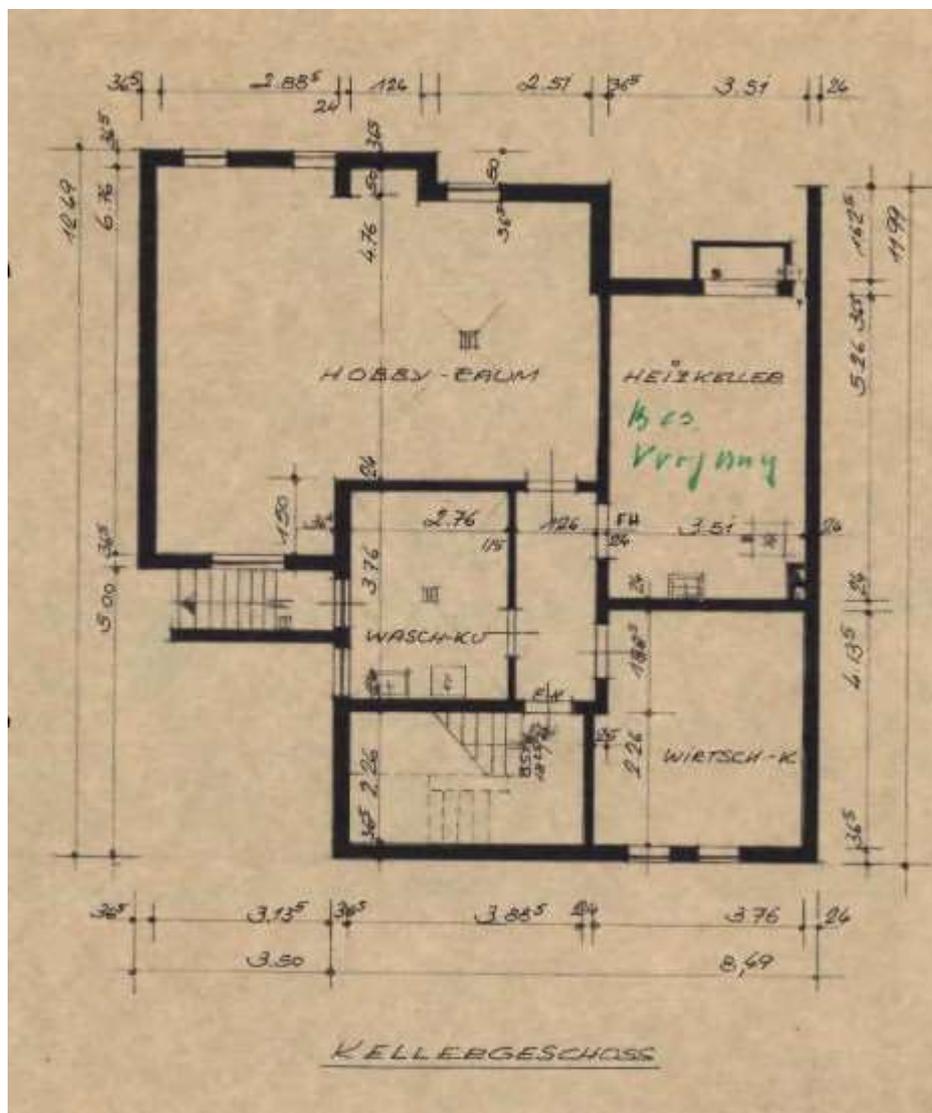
Grundrisse/Ansichten/Schnitt Quelle: Bauakte der Stadt Duisburg
